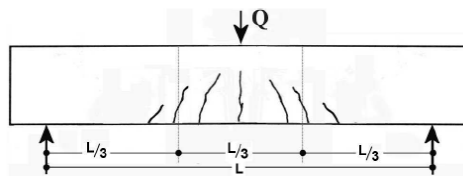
Schéma de fissuration d'une poutre endommagée au moment fléchissant [CROSTON\_06]
